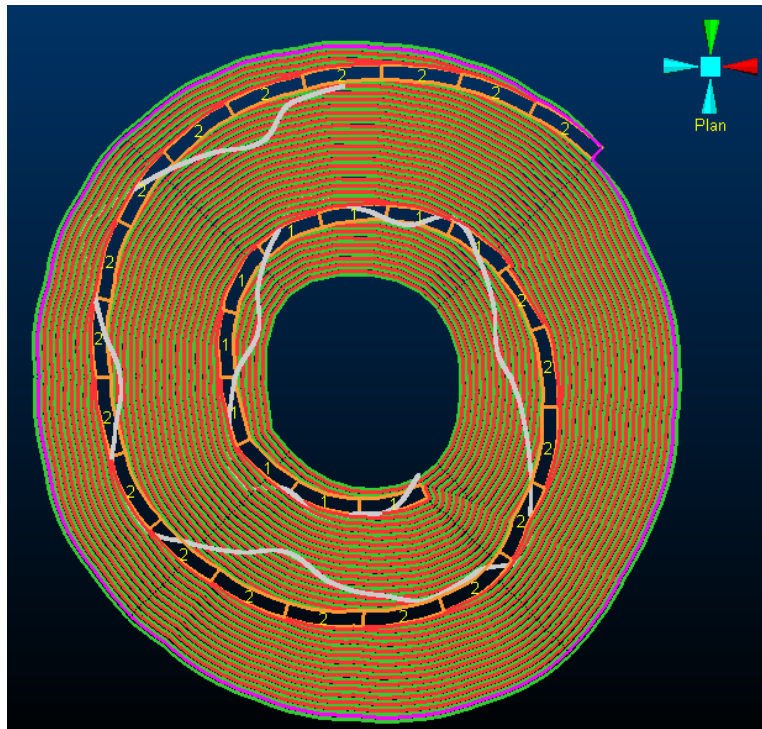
Vista planta ajuste pit suavizado y línea se puntos.
